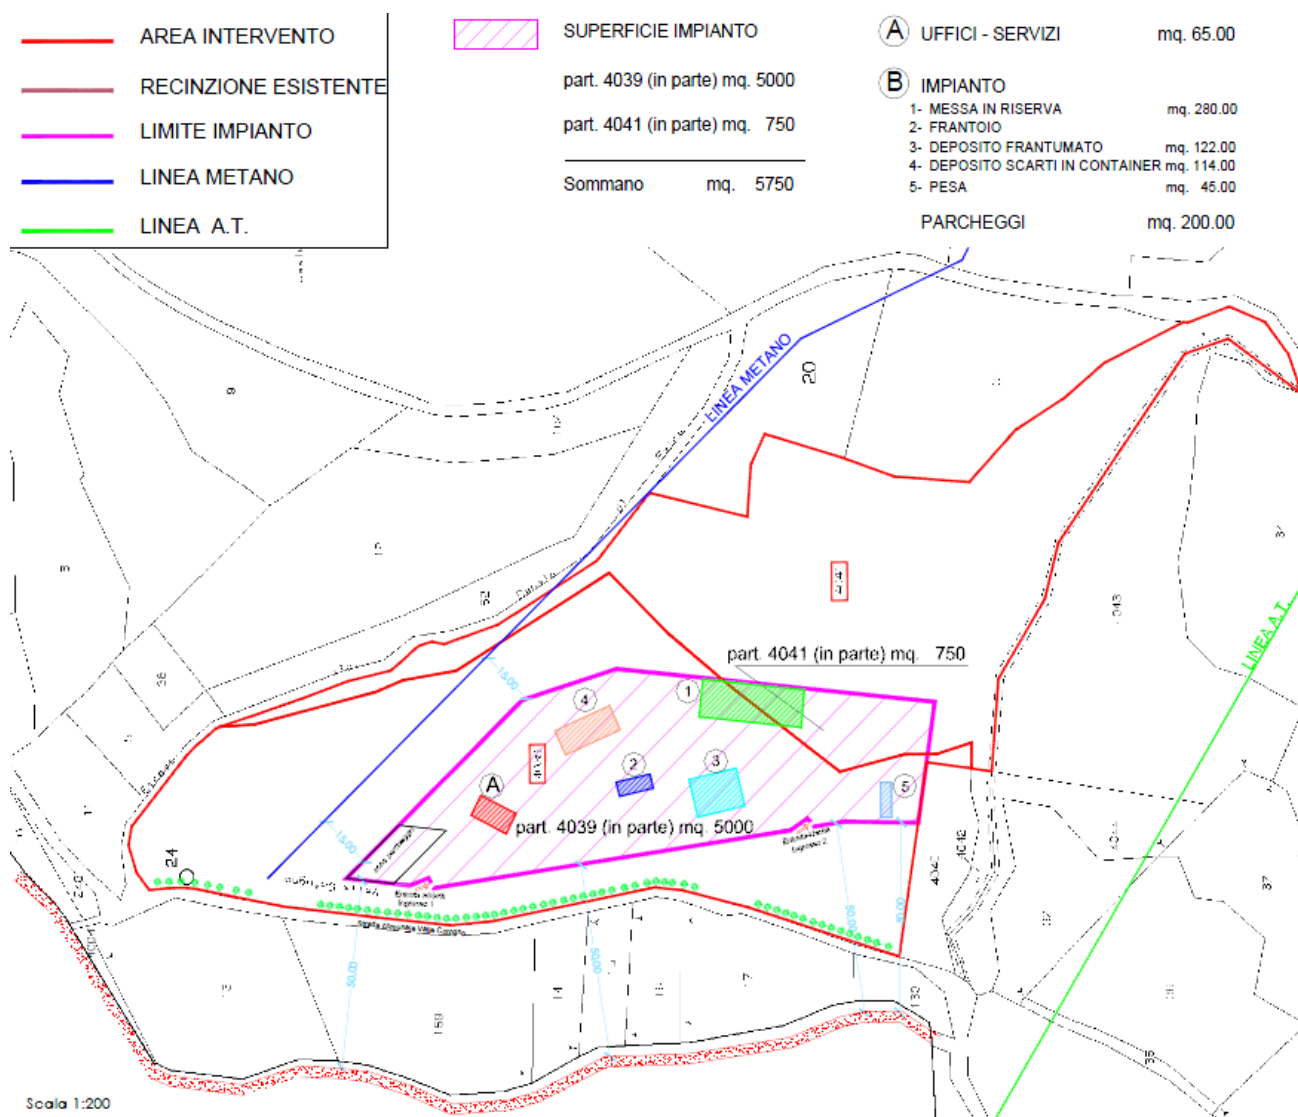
Planimetria con indicazioni e layout dell'impianto.
